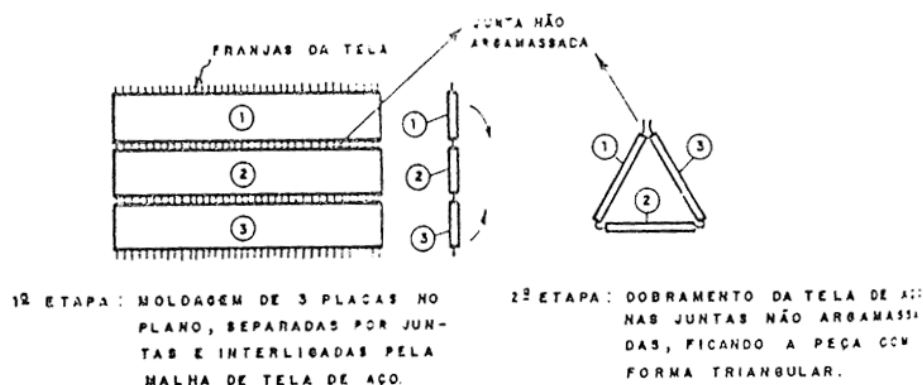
Execução das vigas de "argamassa armada" pelo método de dobradura.
